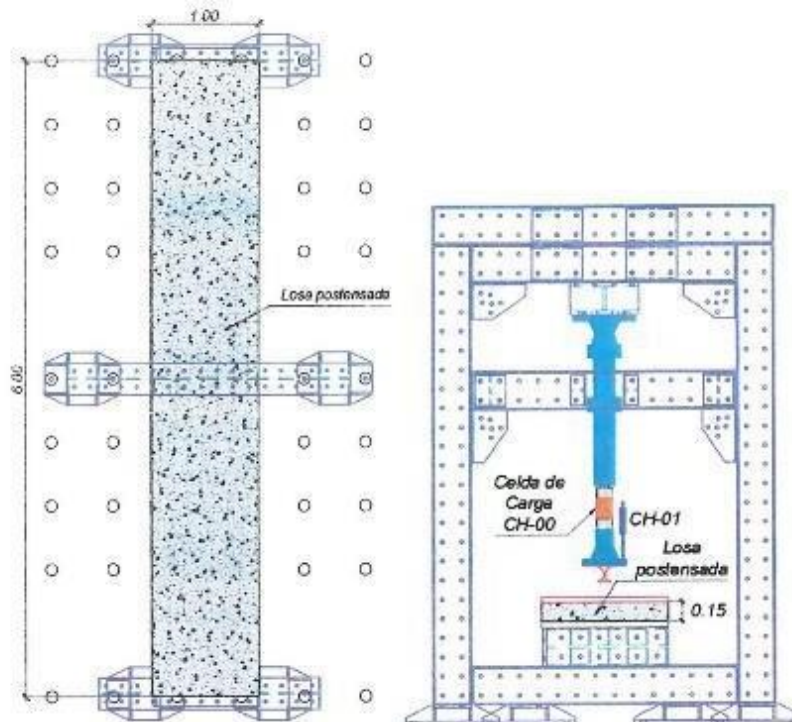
Vista en planta y elevación del mecano de carga y losa postensada
